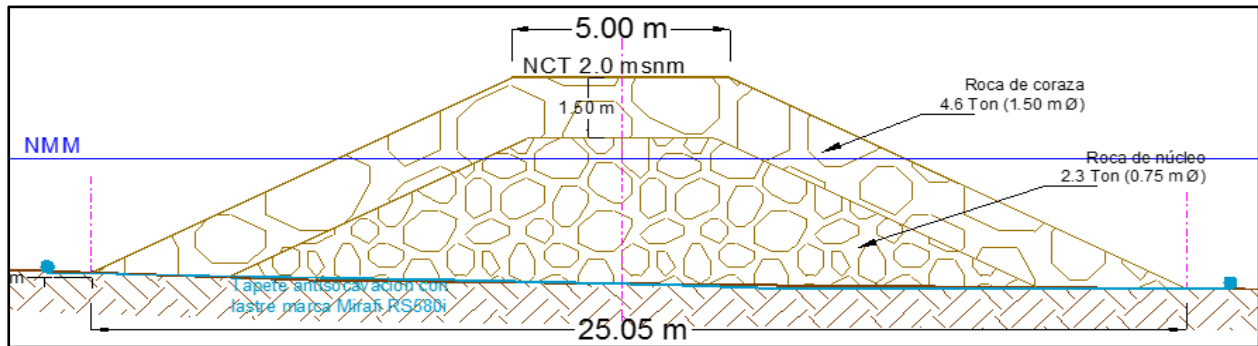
Sección tipo pedraplén y núcleo de rompeolas 1.
